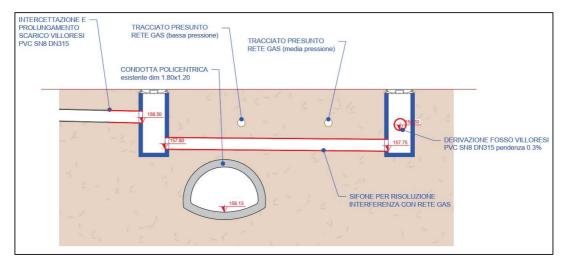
Sezione di progetto del nuovo collegamento al canale 3/5 Nova
